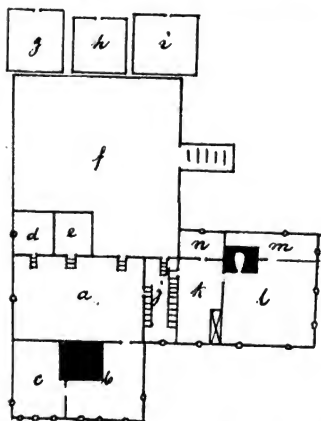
Grundriss des oberen Stockwerkes eines russisch karelischen Hauses.
